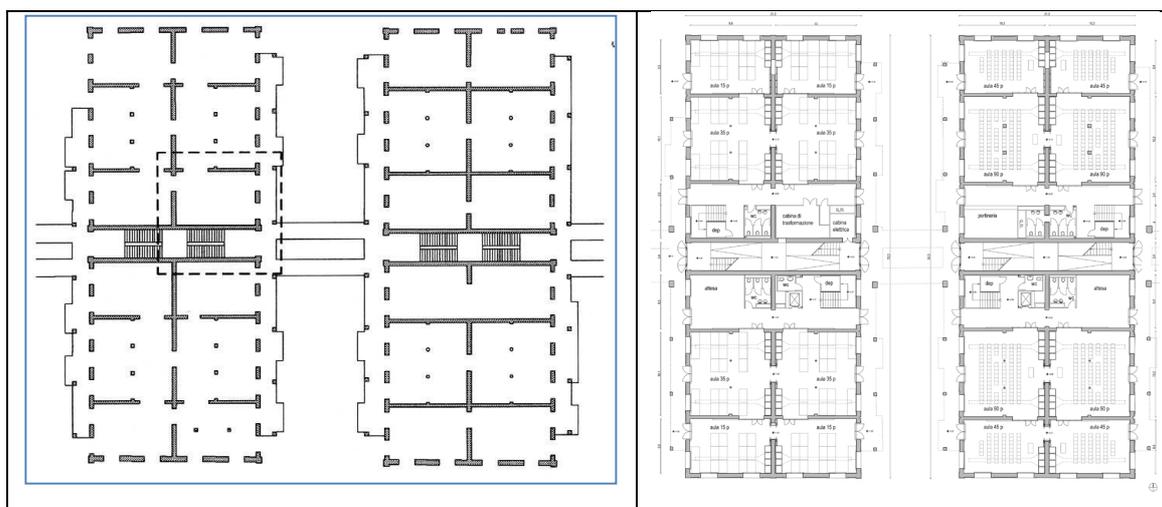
Struttura modulare originale e sistemazione finale al piano primo dei due Magazzini
